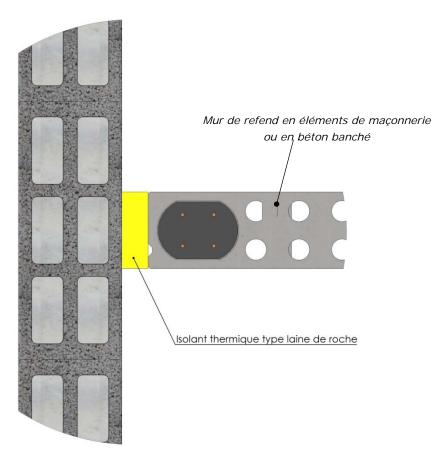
Jonction par juxtaposition d'un mur de refend/mur de façade en zones sismiques
